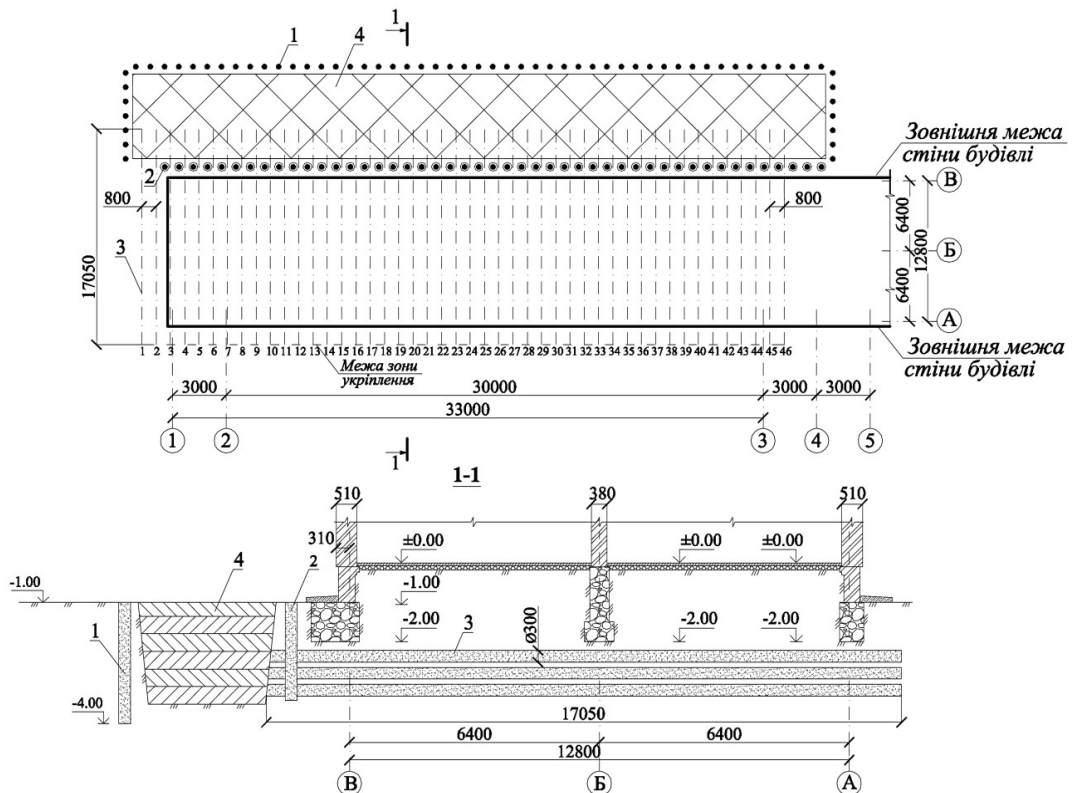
Схема розрізу будівлі з підсиленою основою фундаментів: 1 - ГЦЕ укріплення укосу; 2 - вертикальний ГЦЕ підпірної стінки.
